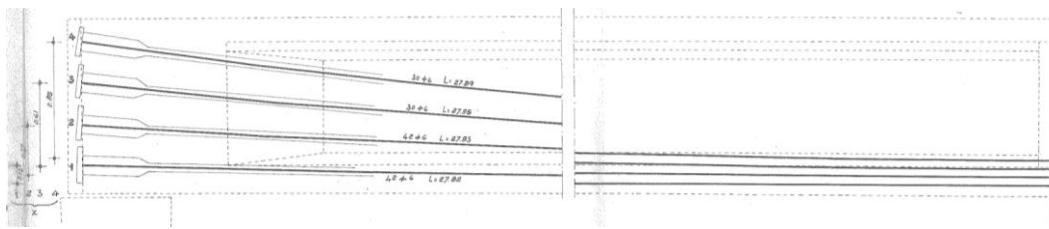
Tracciato dei cavi da precompressione
